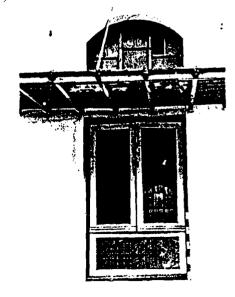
/100331 Detail jendela dan kuncungan di ruang hall
